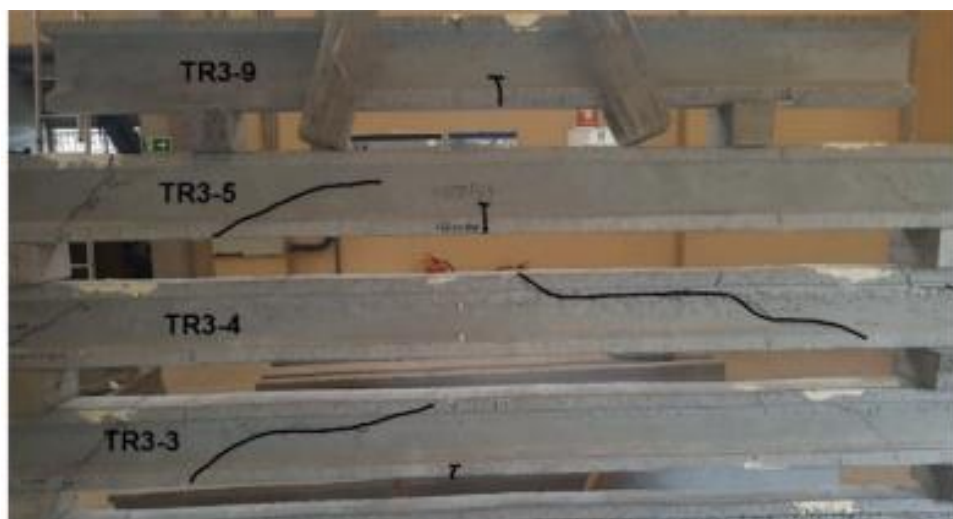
Fissuras por tensão de cisalhamento.
